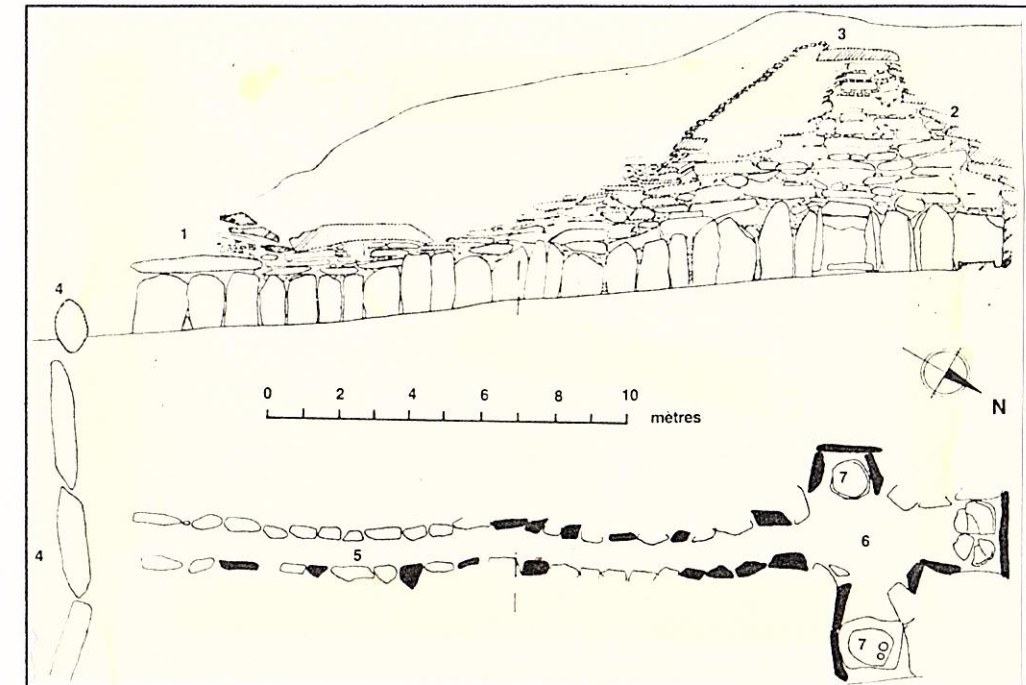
Section et plan du dolmen de Newgrange (R'D).
